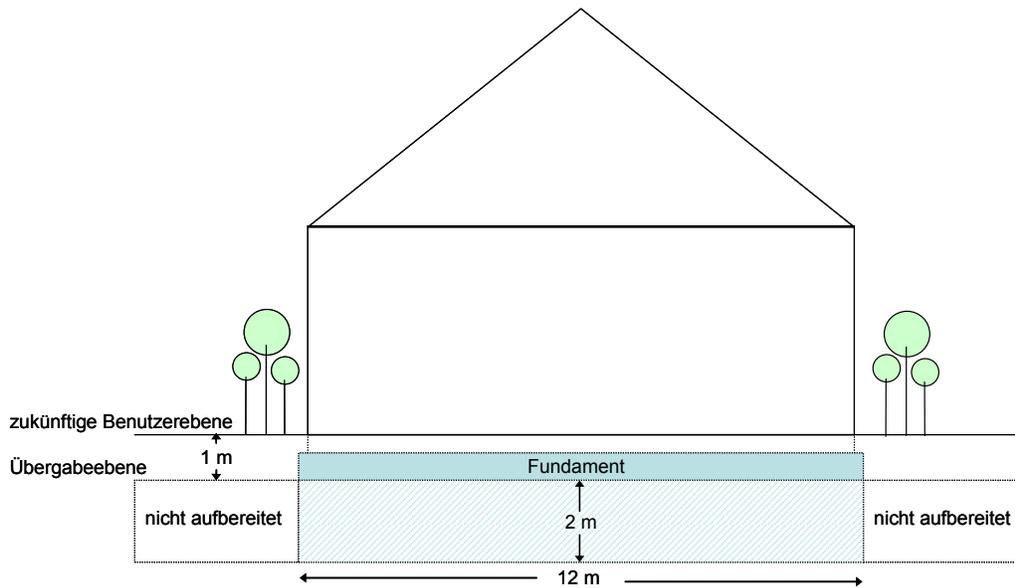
Baugrundaufbereitung gem. Sanierungsplan (vgl. TABERG Ingenieure, Projektnr. 08292, 24.10.2012: Sanierungsplan)
